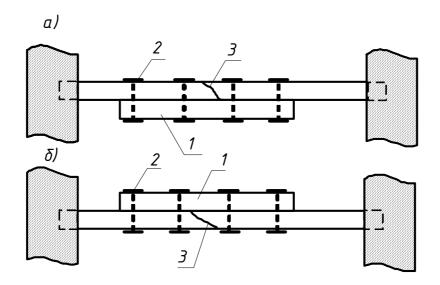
Устройство деревянных накладок на болтах: а - снизу; б - сбоку; 1 — накладки, 2 — болты; 3 — надломленная балка
